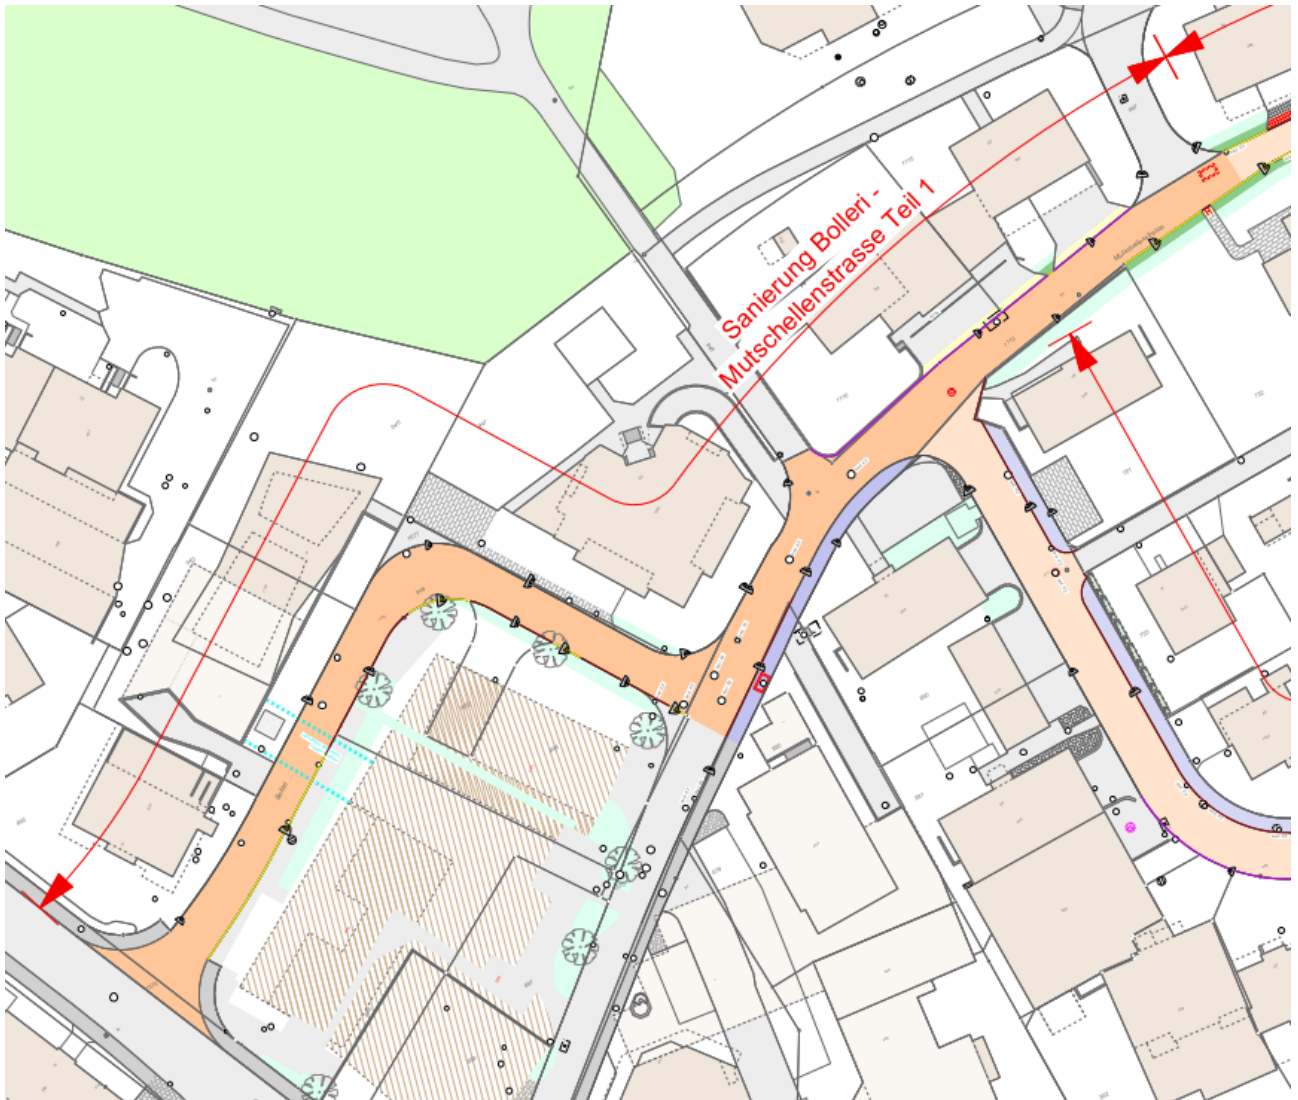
Projektperimeter Bolleri – Mutschellenstrasse Teil 1
